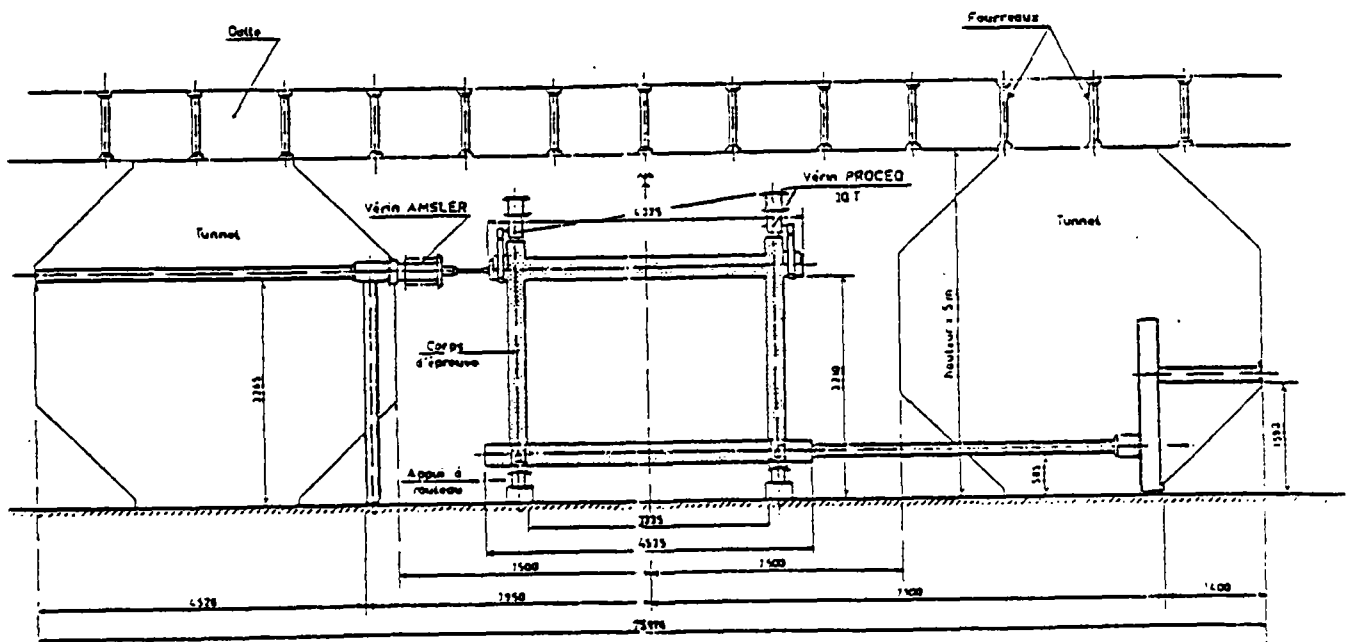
Schéma d'ensemble du banc d'essais
